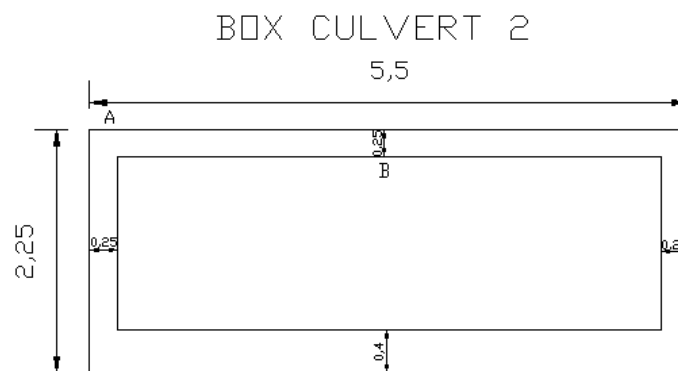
Corte del Box Culvert 2 acotado en metros.
